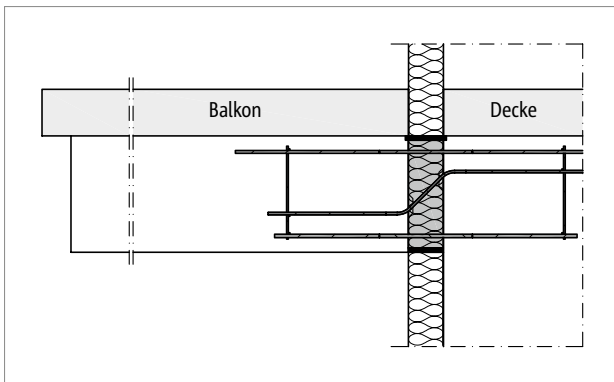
Schöck Isokorb® XT Typ BP: Balkonkonstruktion mit frei auskragenden Unterzügen (Fertigteilbalkon)
